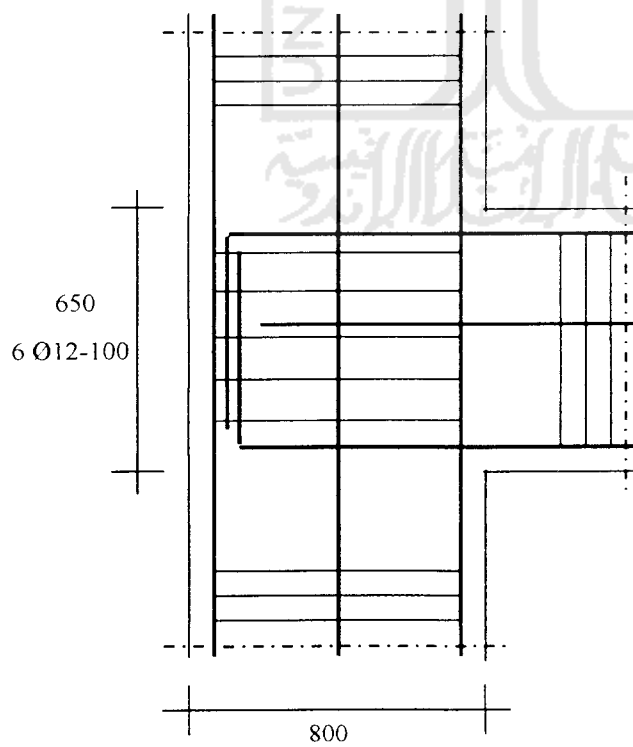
Detail join Balok Kolom D Lantai 12
